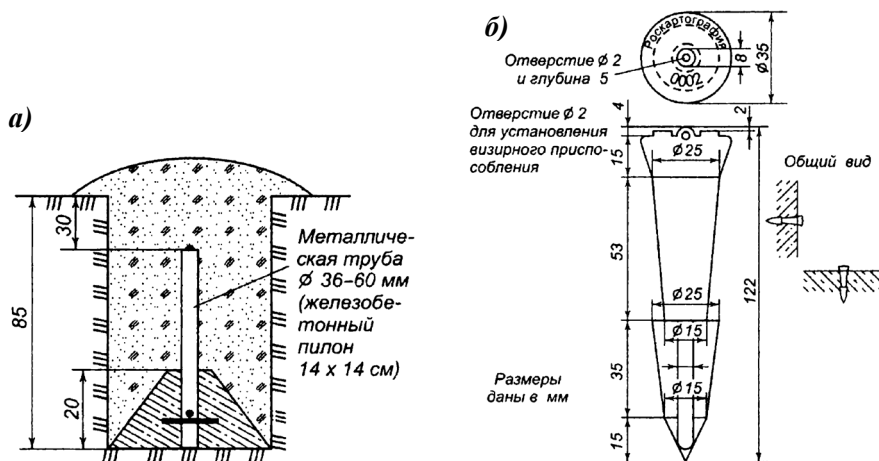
Конструкции центров для закрепления пунктов ГГС 1-4 классов: а) тип 7 оп.; б) тип 92 (тур)
